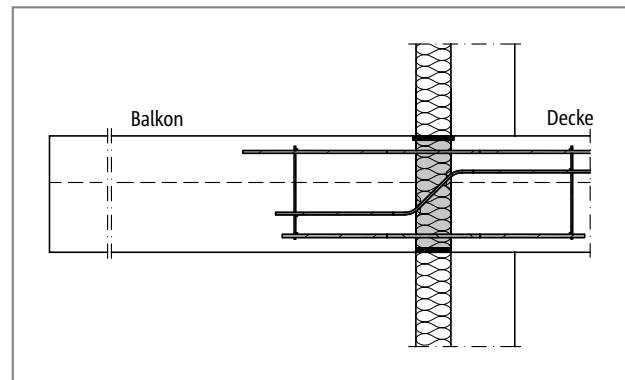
Schöck Isokorb® XT Typ BP: Balkonkonstruktion mit frei auskragenden Unterzügen
